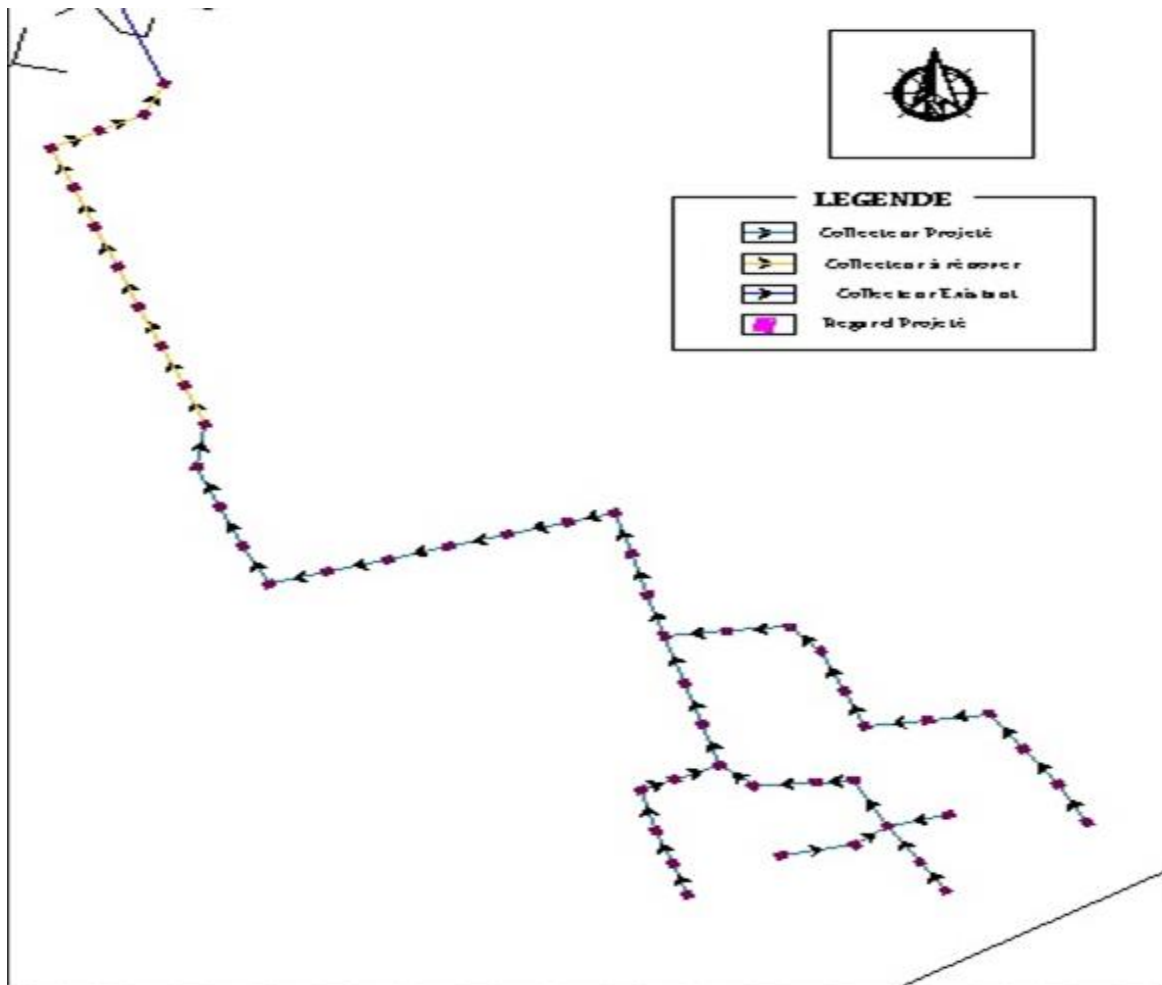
Vue en plan du Système d'assainissement projeté
